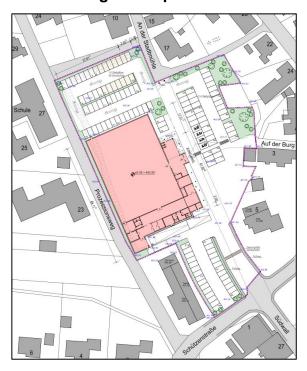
Bebauungskonzept (Architektin: H. Köster-Saure, Medebach – Stand: 11/2023)
